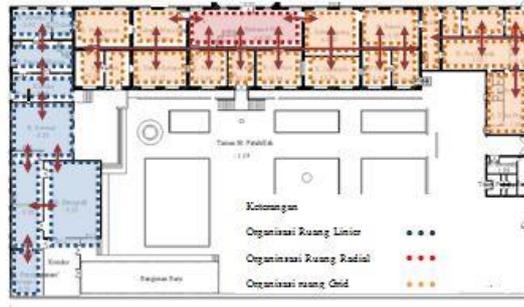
fungsi ruang lantai mezanin dan lantai 2
